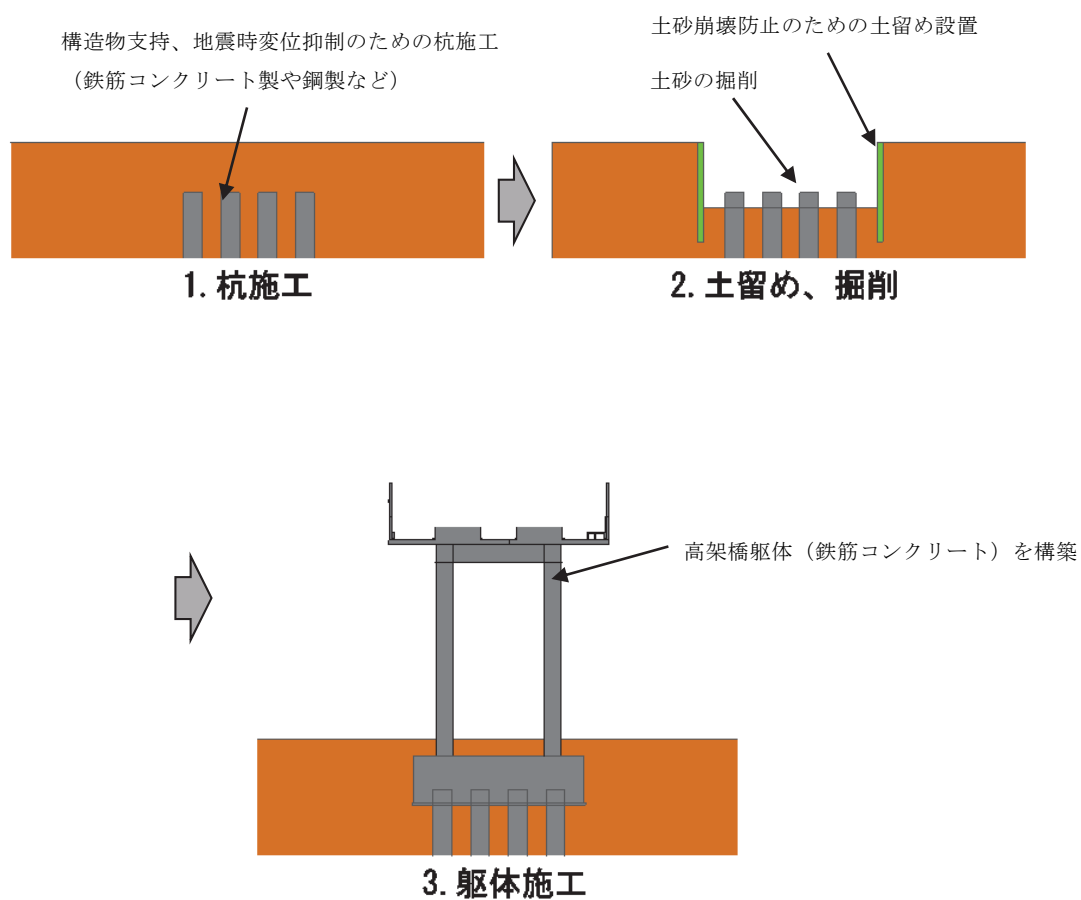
高架橋の施工イメージ ※場所打ち工法の場合
